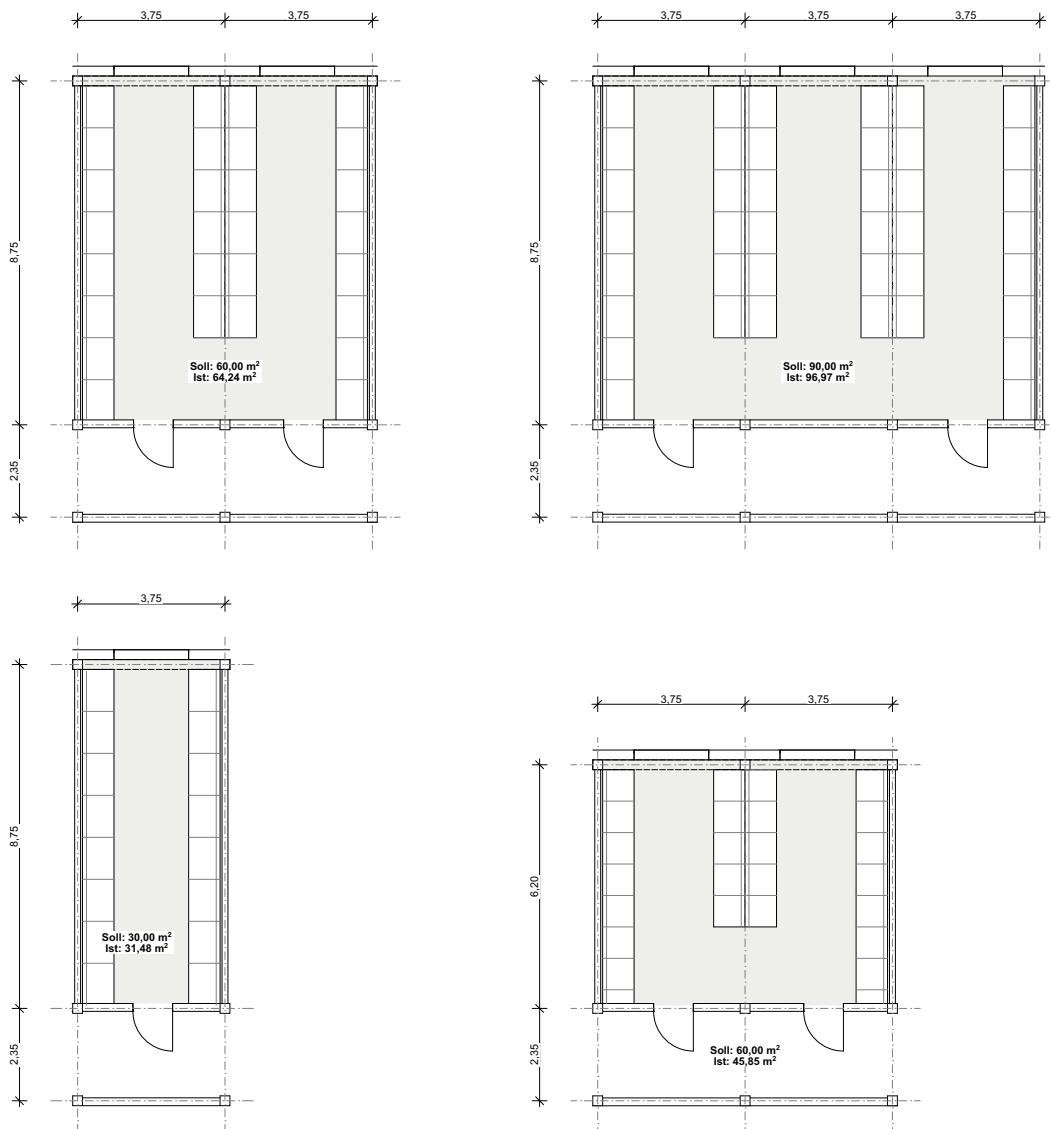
Grundrisse Laboreinheit (Möbelierungsvorschlag nach doranth post architekten (2020b))
